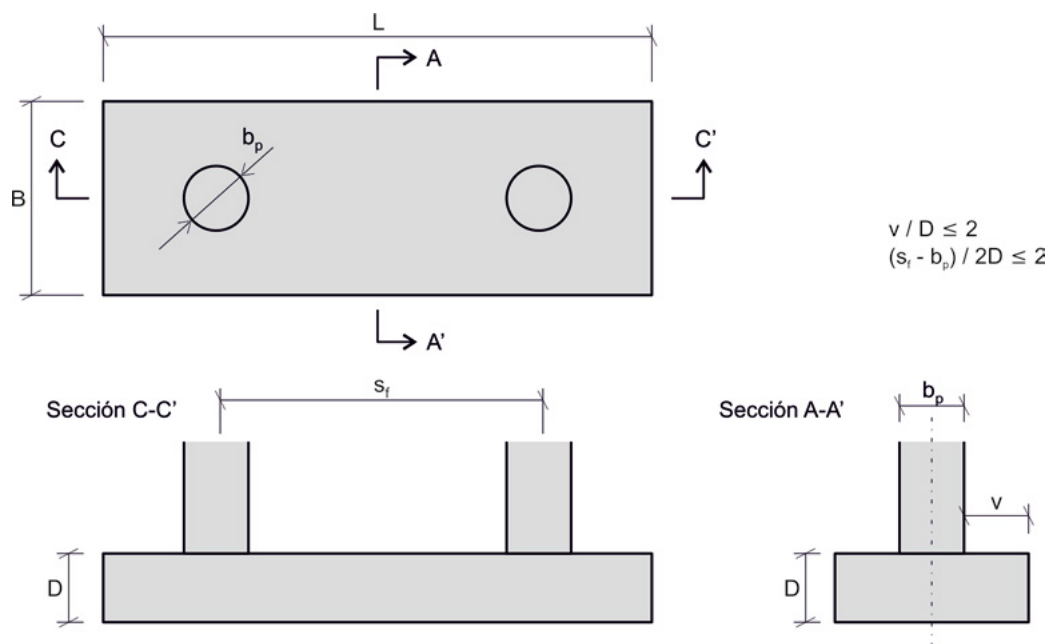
Criterios de rigidez estructural para zapata con dos fustes
